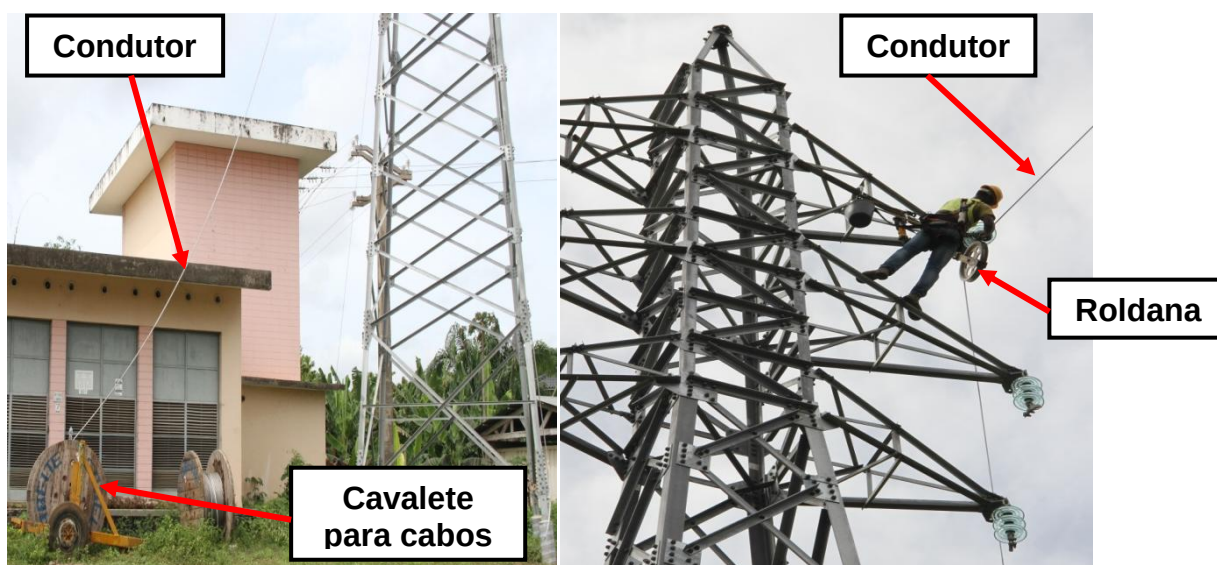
Desenrolamento de condutores com cavalete para bobinas e montagem em roldanas
